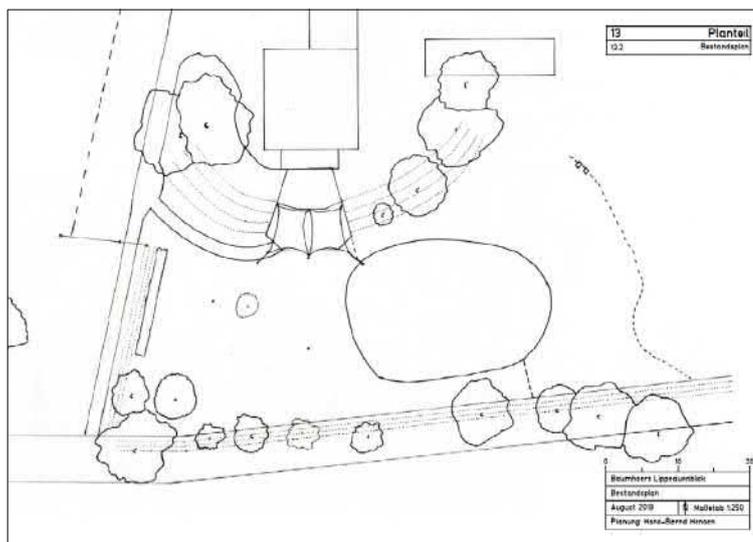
Bestandsplan. Verkleinerter Ausschnitt aus Planteil 10.2 Bestandsplan.
